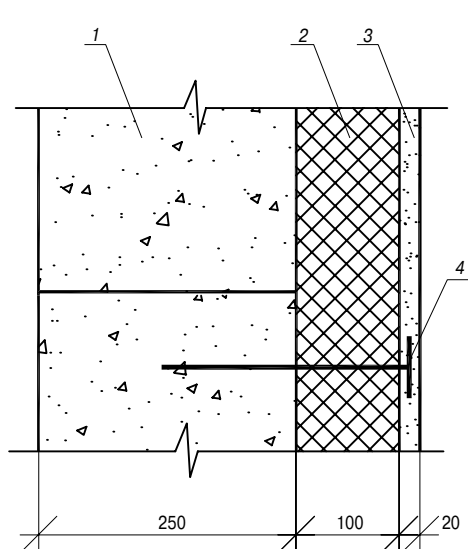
Конструкция наружной стены: 1 – кладка из газобетонных блоков марки по плотности D600; 2 – утеплитель минераловатный; 3 – штукатурный слой; 4 – тарельчатый дюбель
